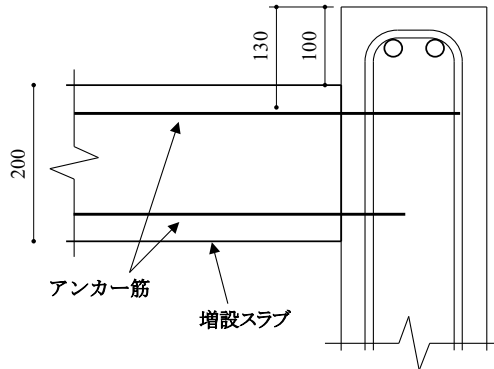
スラブ上端筋に使用するアンカー筋とスラブ支持梁の断面・配筋
